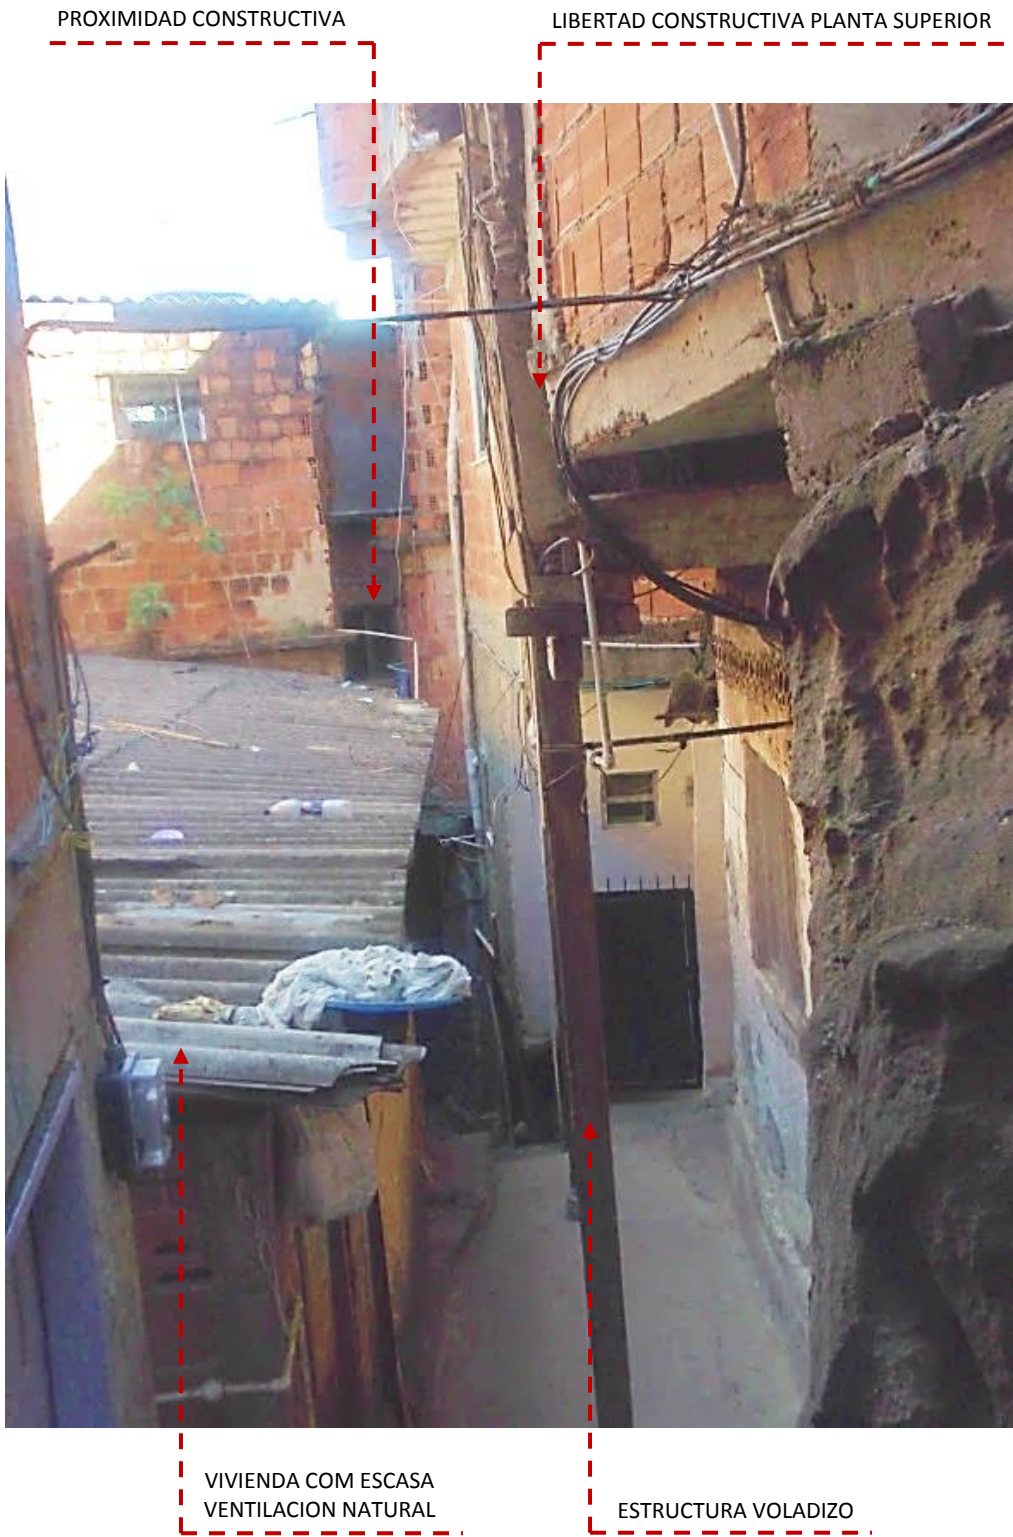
Viela obstaculizada por el refuerzo de la construcción en la primera planta
